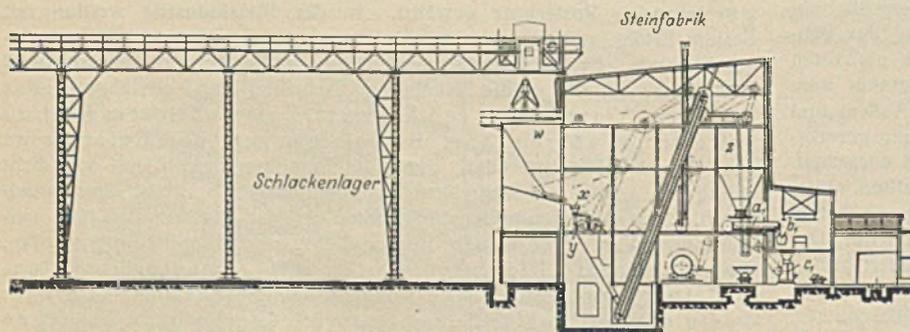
Steinfabrik und Schlackelagerplatz mit Greiferkrananlage.
